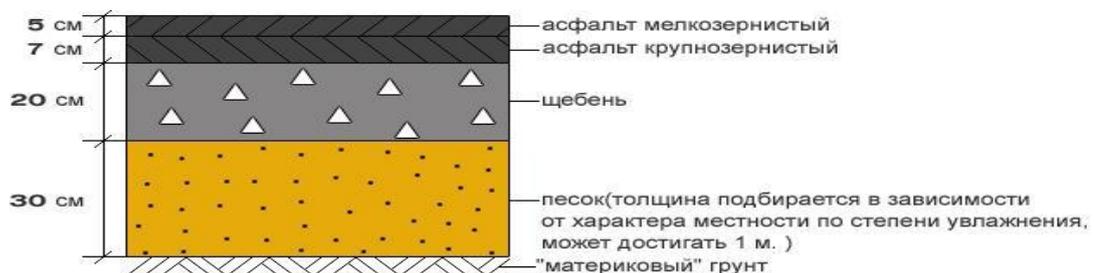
Схематический чертеж поперечного сечения конструкции автодороги
